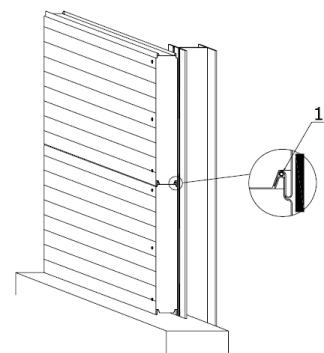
Установка уплотнителя. 1 – трубчатый уплотнитель (герметик)
